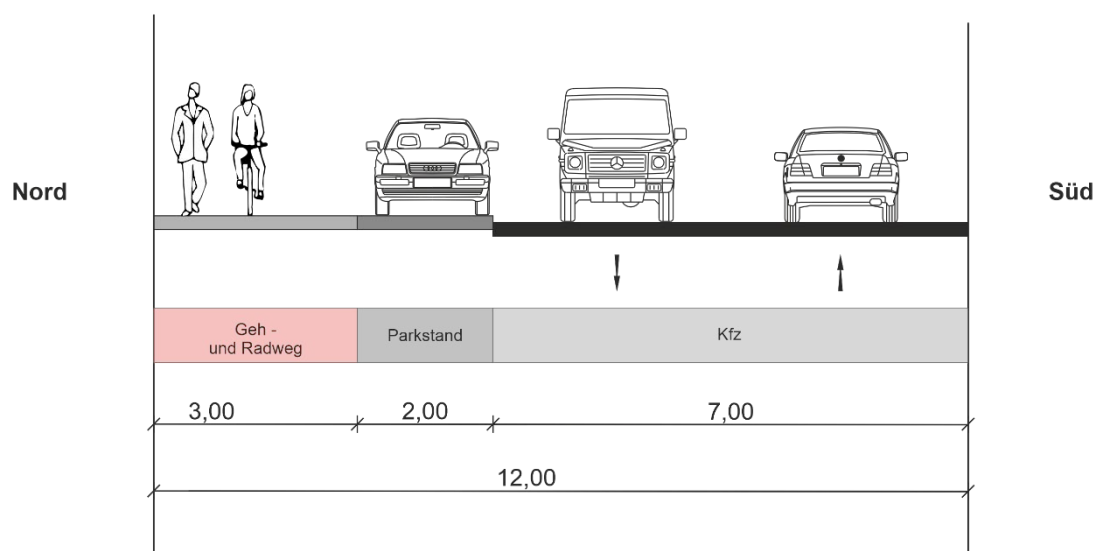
Planfall 1 –Fahrbahnquerschnitt östliche Bamberger Straße.
